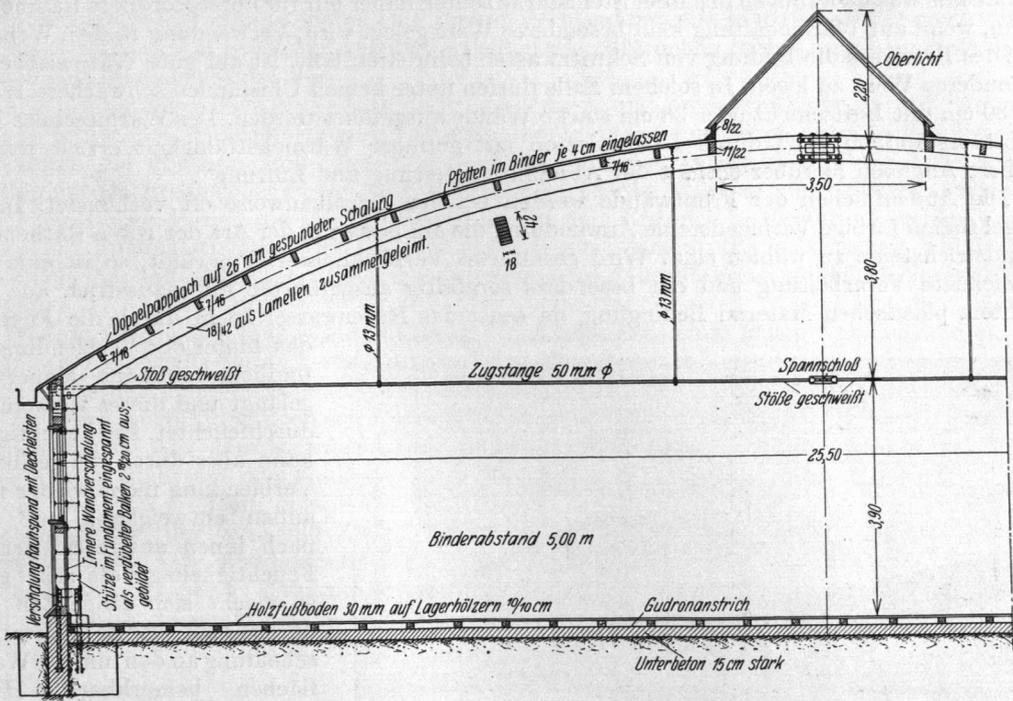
Lagerhalle in Holzbauweise mit Lamellenbogenbindern.
